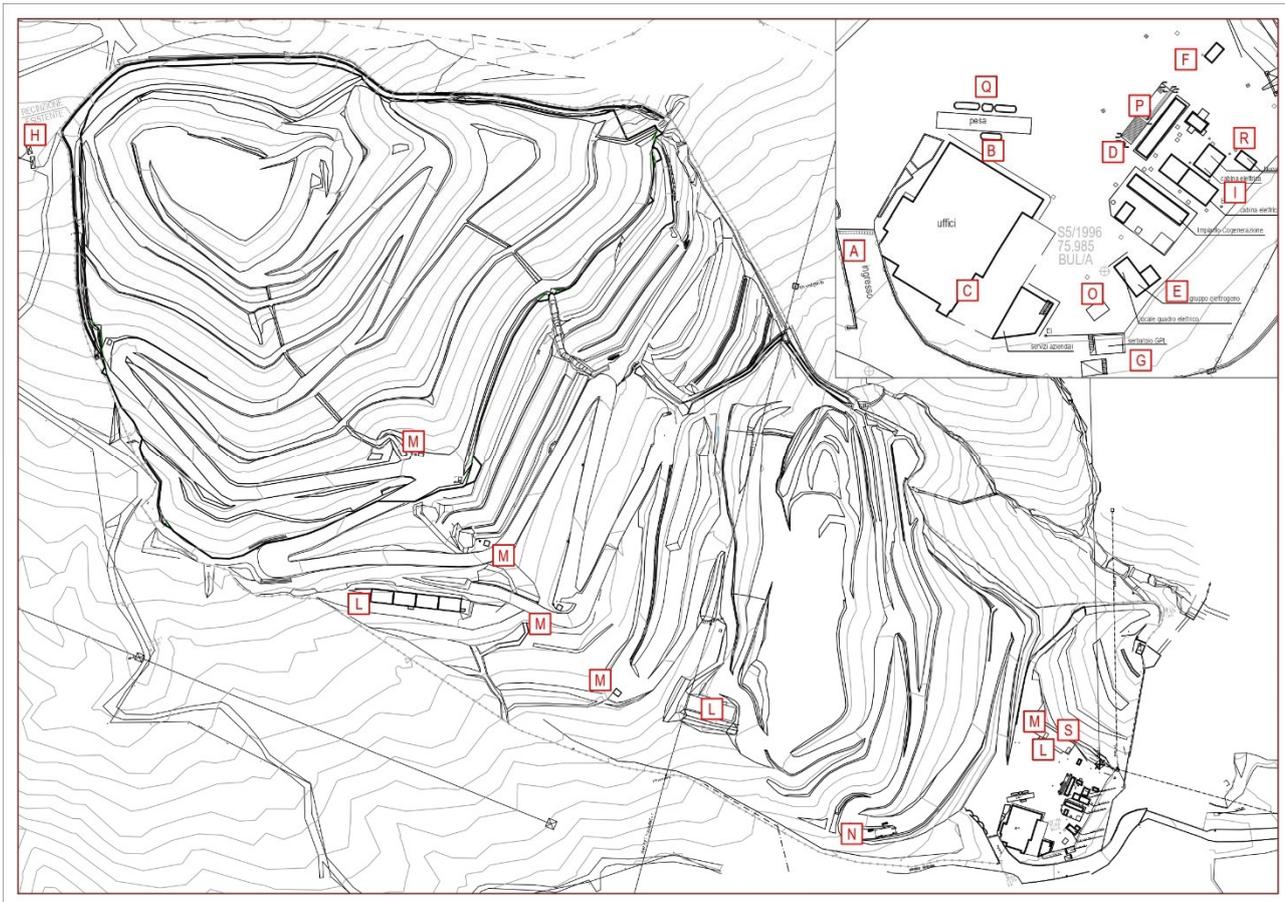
Impianto di Bossarino – Planimetria allo stato attuale
